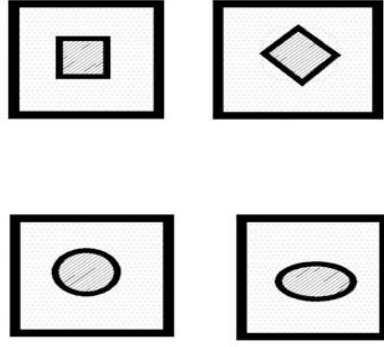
İç Sofalı Plan Tipi (Bektaş 1996)
